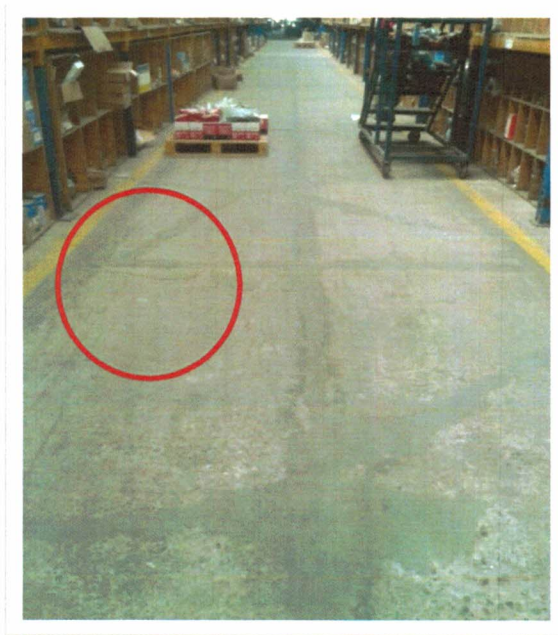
VISTA DE FISURAMIENTO.
